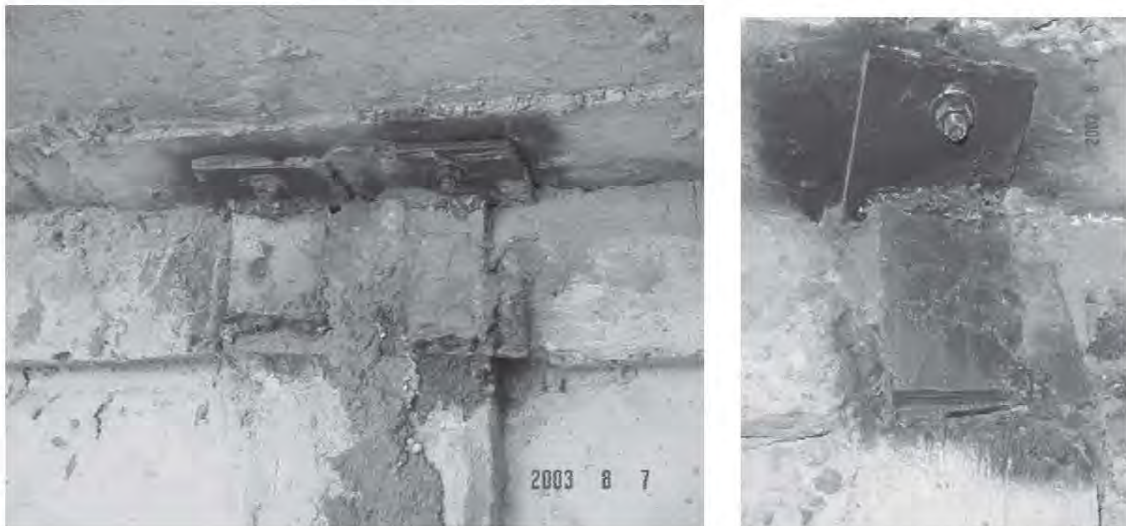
Detalle de conexión de elementos prefabricados
